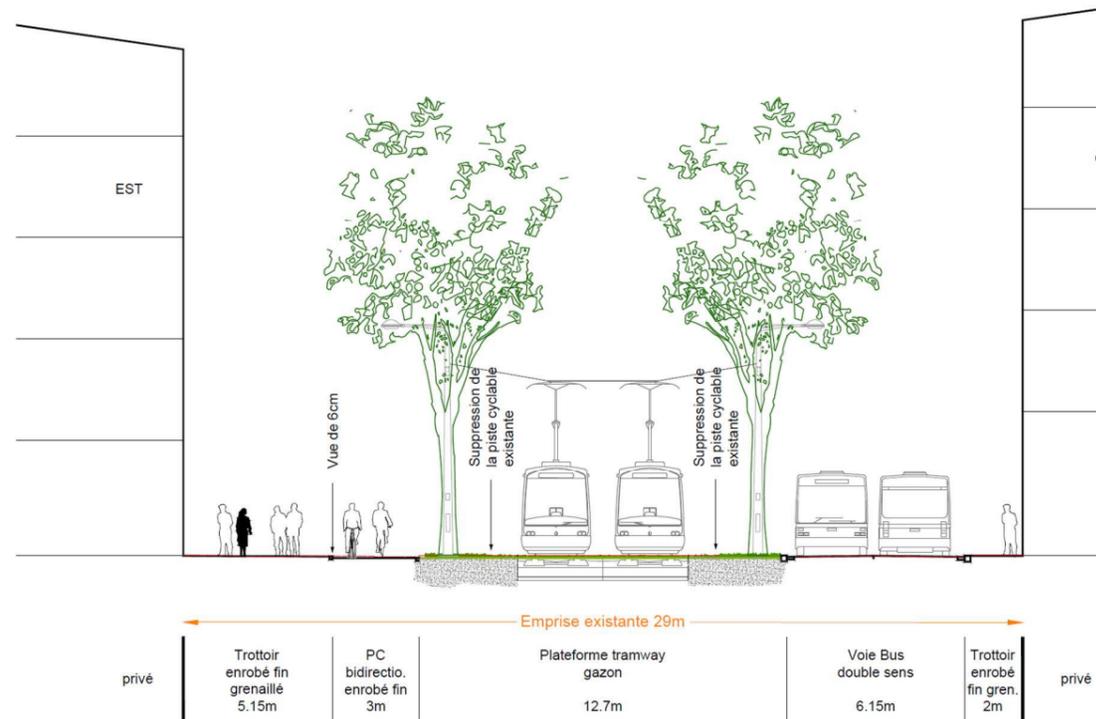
Coupe du boulevard Wilson sur la section entre Place de la Gare et le Fbg de Saverne (source : AVP GETAS, 2023)
